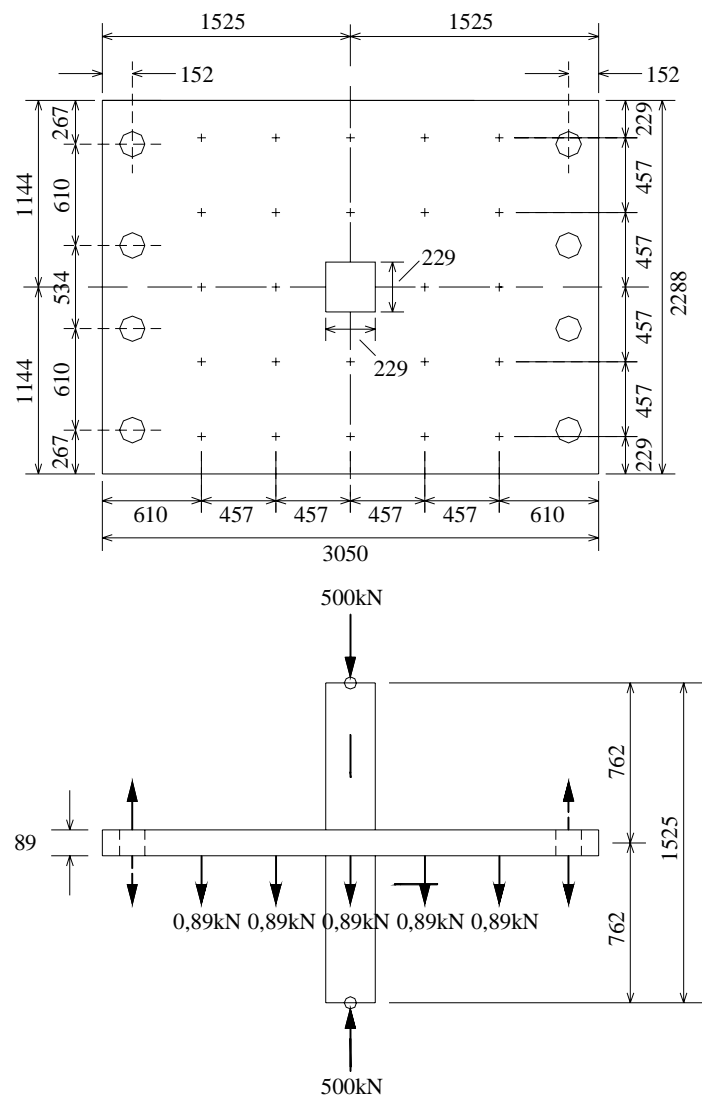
Dimensões e carregamento das lajes de ISLAM & PARK (1976) (mm)
